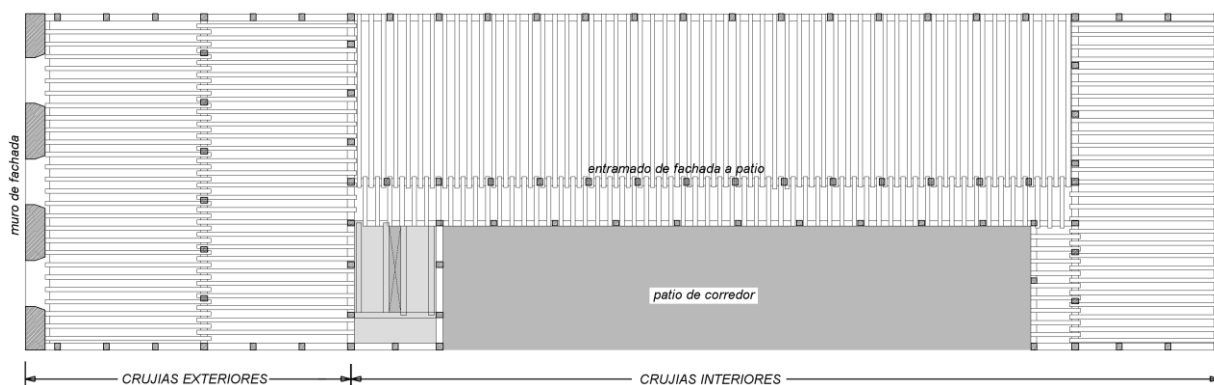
Planta de estructura de una corrala típica con patio a medianera
